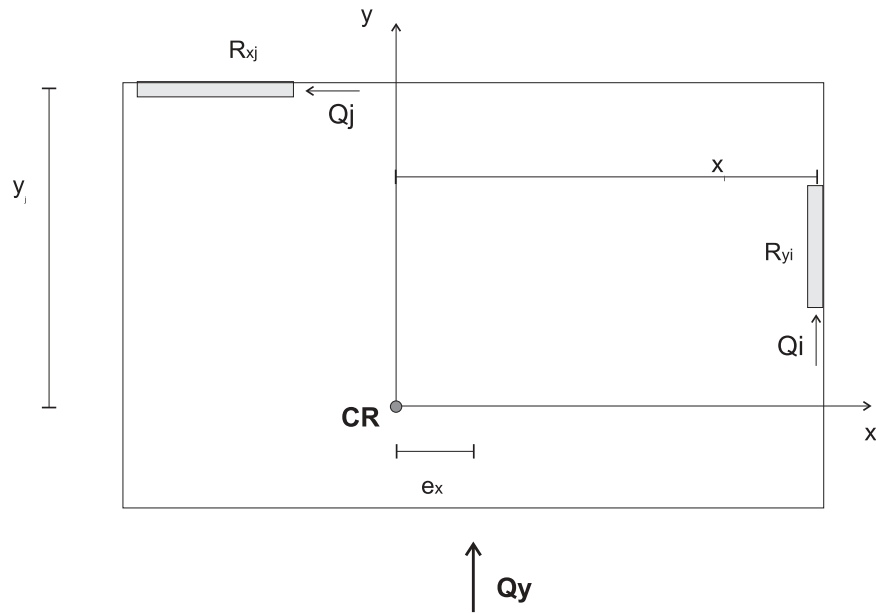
Ubicación de los elementos estructurales en relación al centro de rigidez
